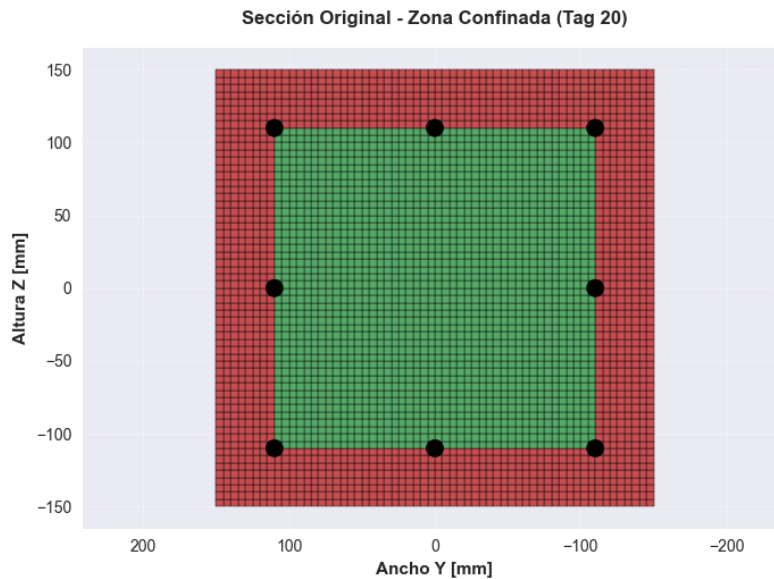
Discretización de una sección transversal en fibras de hormigón y acero
